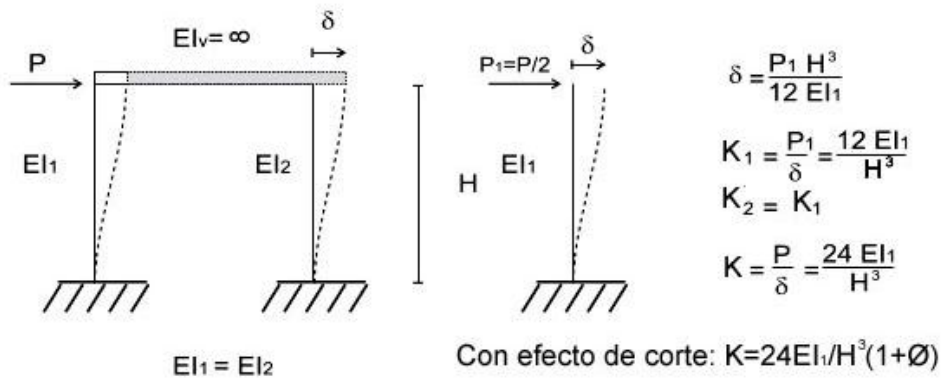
A.5 Rigidez de columna en el plano de un pórtico simple
